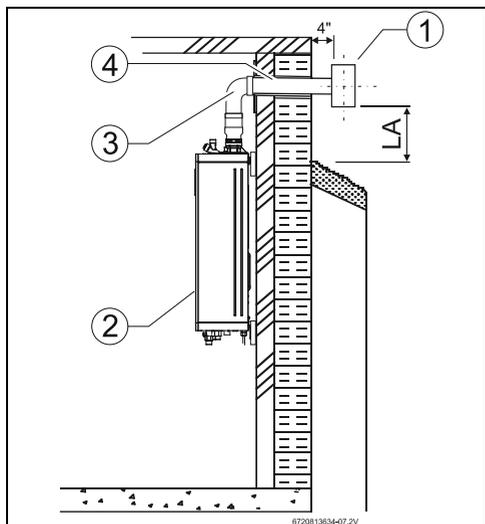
Installation de ventilation horizontale (tuyau d'air de combustion non illustré)
